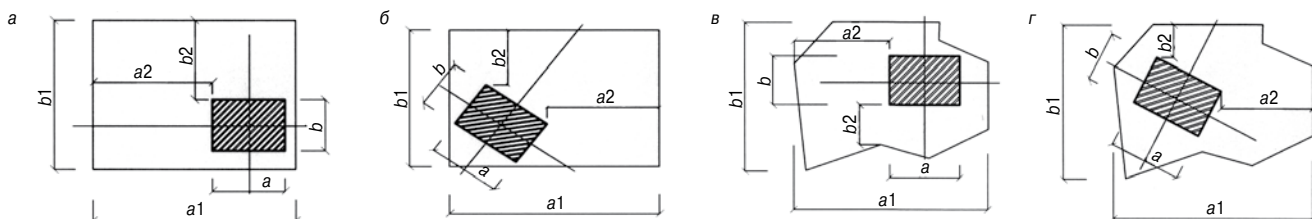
Схемы формирования земельных участков со зданиями, смещенными относительно геометрического центра: а, б – прямоугольная или квадратная форма земельного участка, для зданий этажностью 5–8 эт.; в, г – произвольная форма земельного участка, для зданий этажностью 5–8 эт.; а, в – стороны здания параллельны хотя бы одной из сторон земельного участка; б, г – стороны здания расположены под углом к сторонам земельного участка
